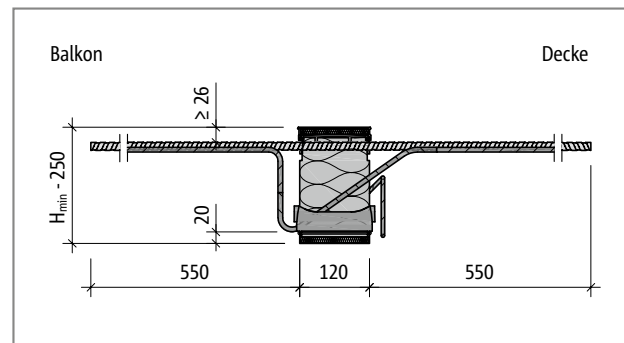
Schöck Isokorb® CXT Typ K-M10-V2: Produktschnitt
